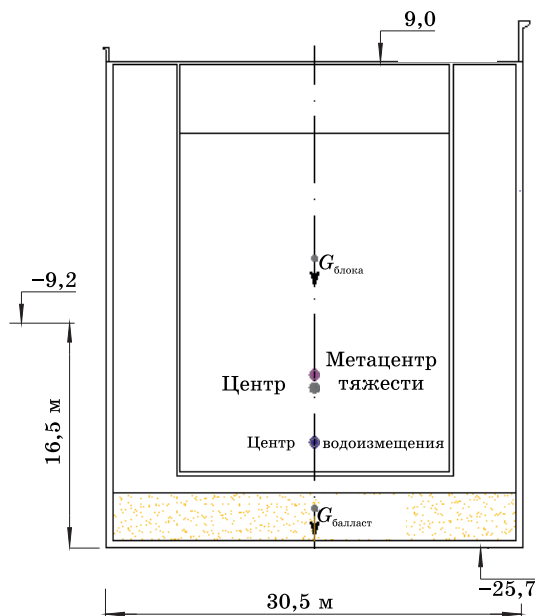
Действие нагрузок на наплавные железобетонные блоки при транспортировке
